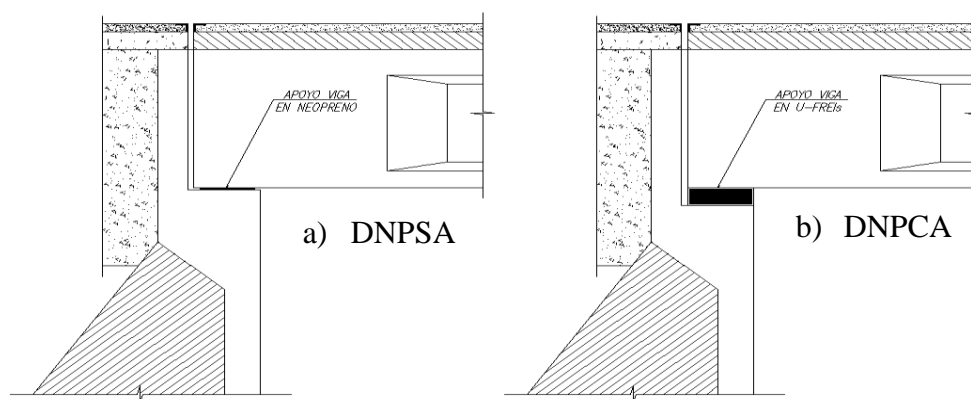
Detalle del apoyo de las vigas postensadas a la subestructura a) con el neopreno (DNPSA) y b) con los aisladores (DNPCA).
